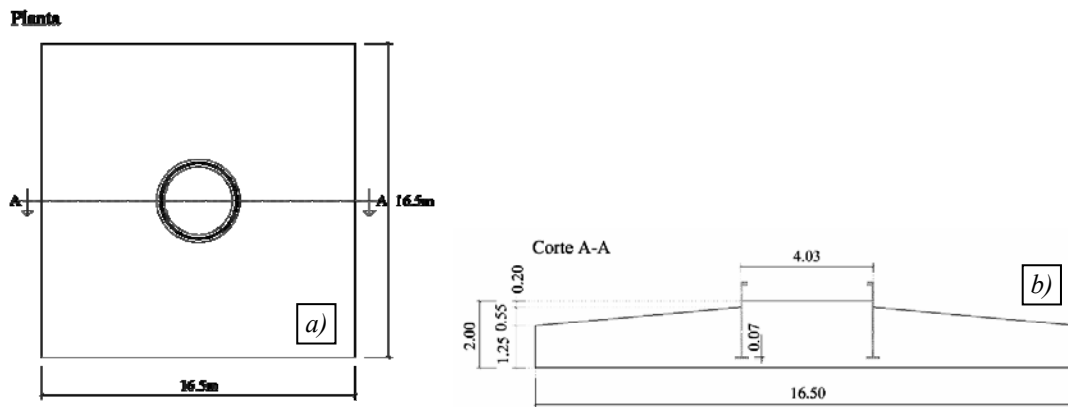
a) Planta da sapata; b) Corte A-A da Sapata
